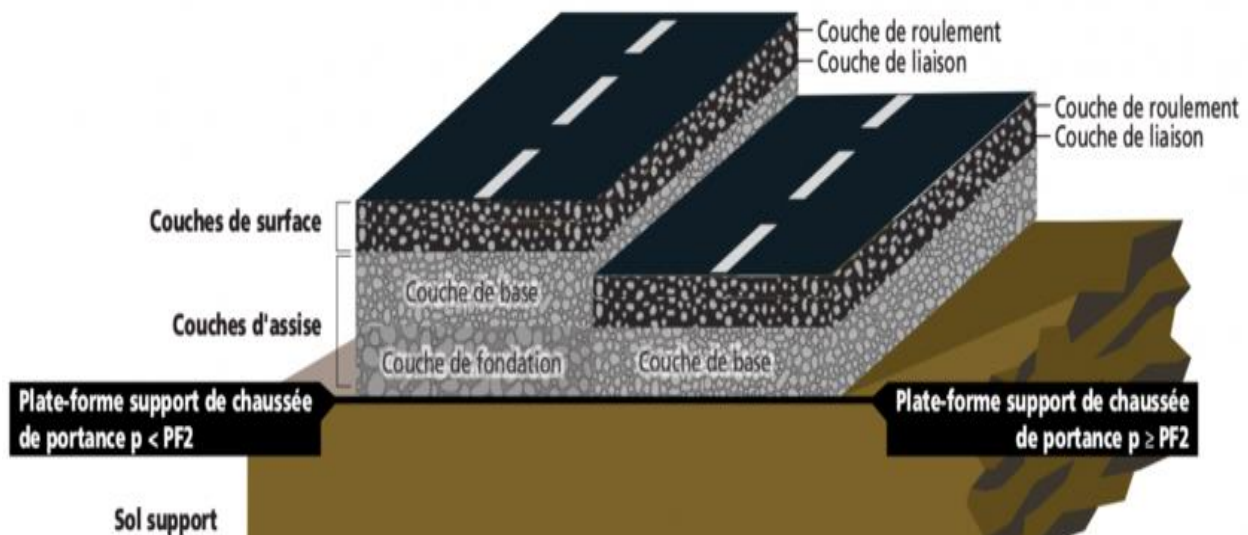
Structure type d'une chaussée semi-rigide. [17]
